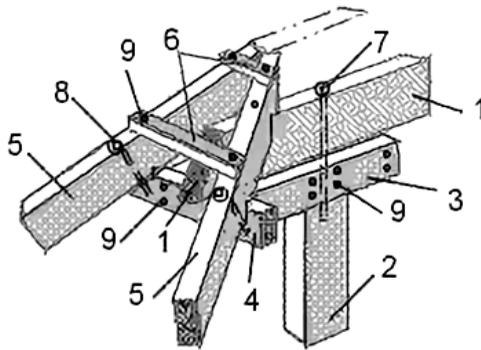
Опорный узел крепления диагональных стропильных ног на коньковый прогон без опоры на подкосы для вальмового ската:
